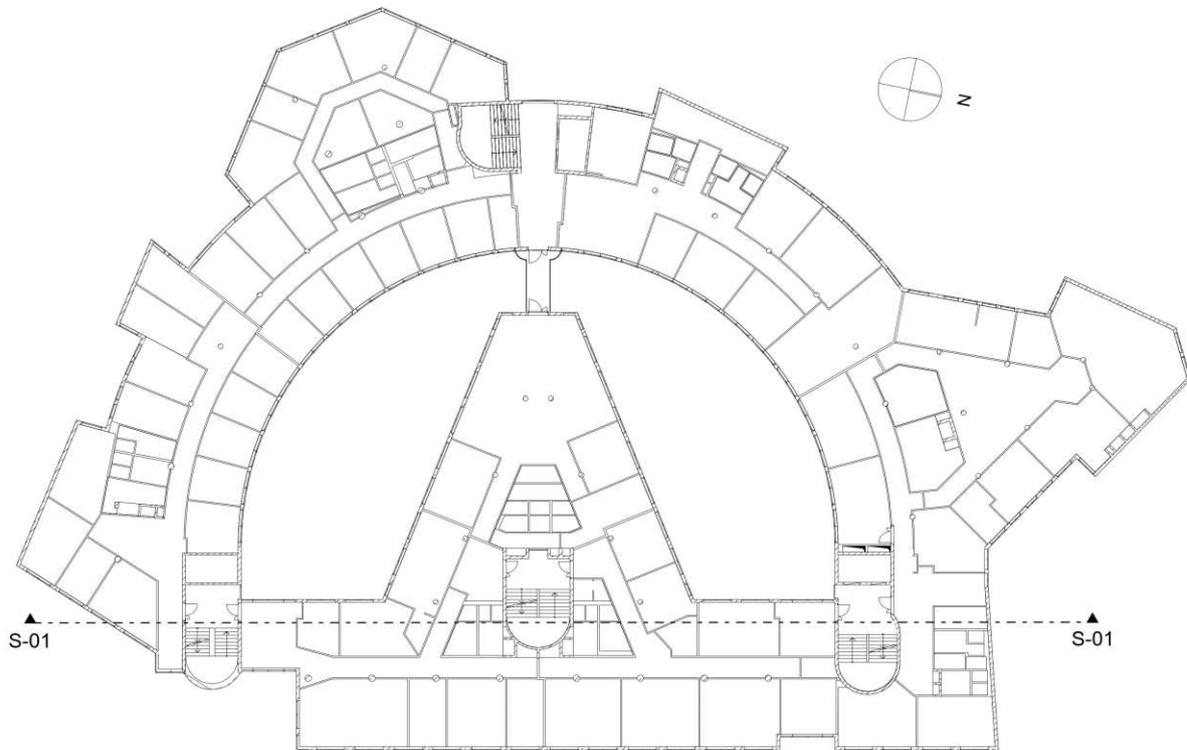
Grundriss 2. Obergeschoss
